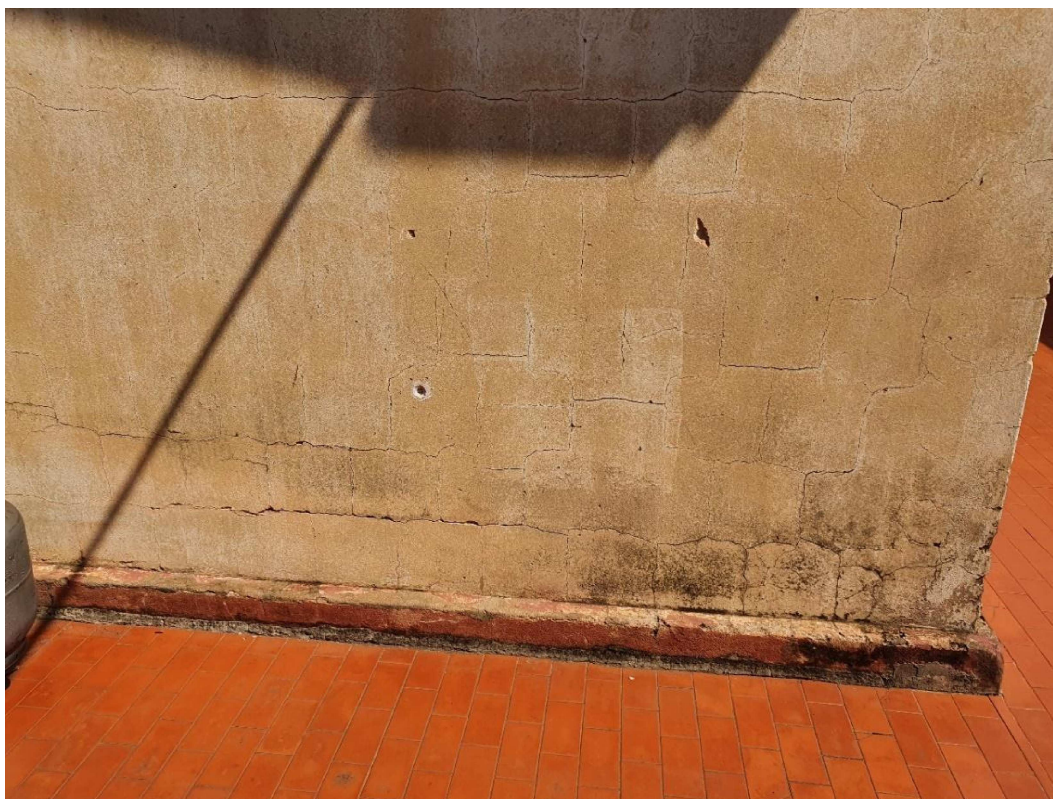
Vista do muro e portão da entrada da casa, reboco caindo e muitas rachaduras, falta de vários pisos cerâmicos.
